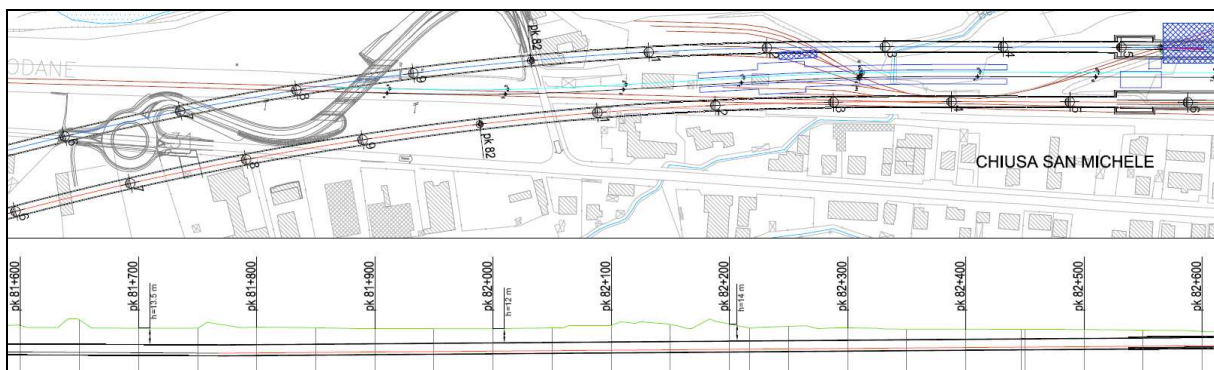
Tunnel dell'Orsiera - Stralcio Sottoattraversamento Chiusa San Michele - Planimetria + Profili
